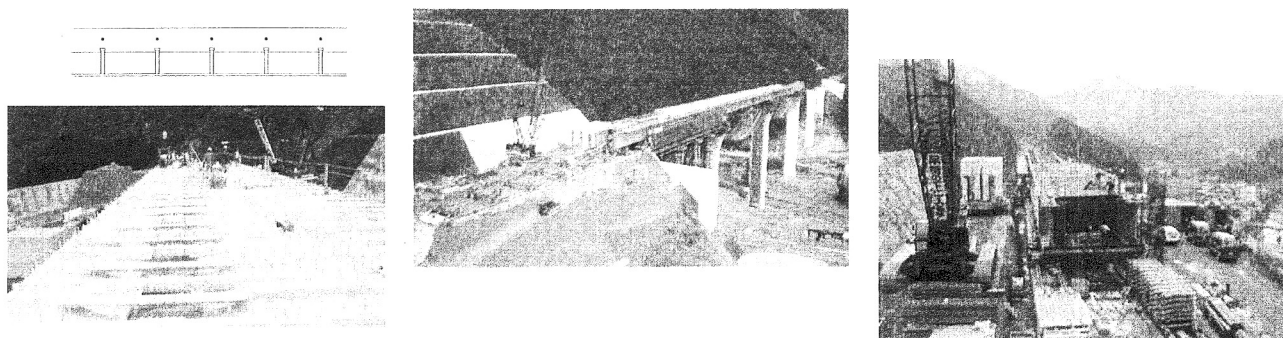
合成床版の施工事例 II：少数 I 桁橋への適用（送出し架設の例）
